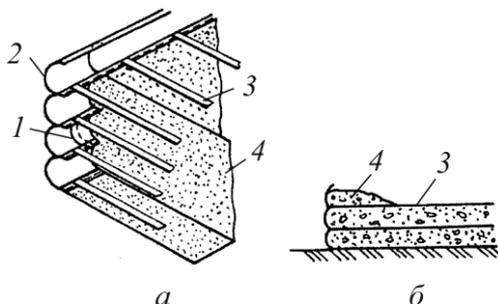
Армированный грунт: *а* – конструкция армированной стенки; *б* – технология устройства; 1 – соединение внахлест; 2 – металлический элемент оболочки; 3 – арматура; 4 – грунт
